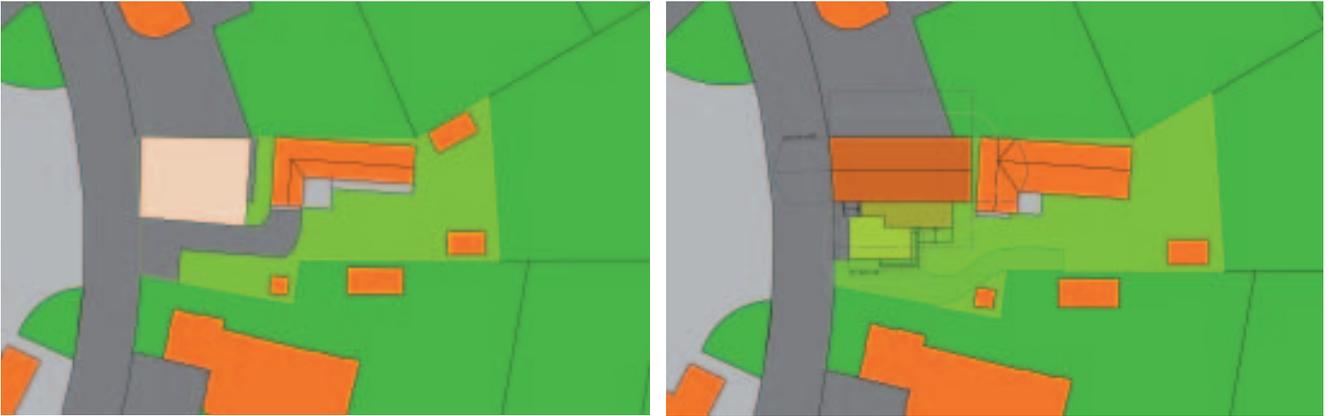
+3: Lageplan vorher (links) und nachher (rechts)
